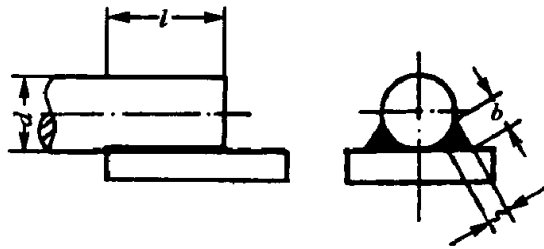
钢筋与钢板搭接焊接头
